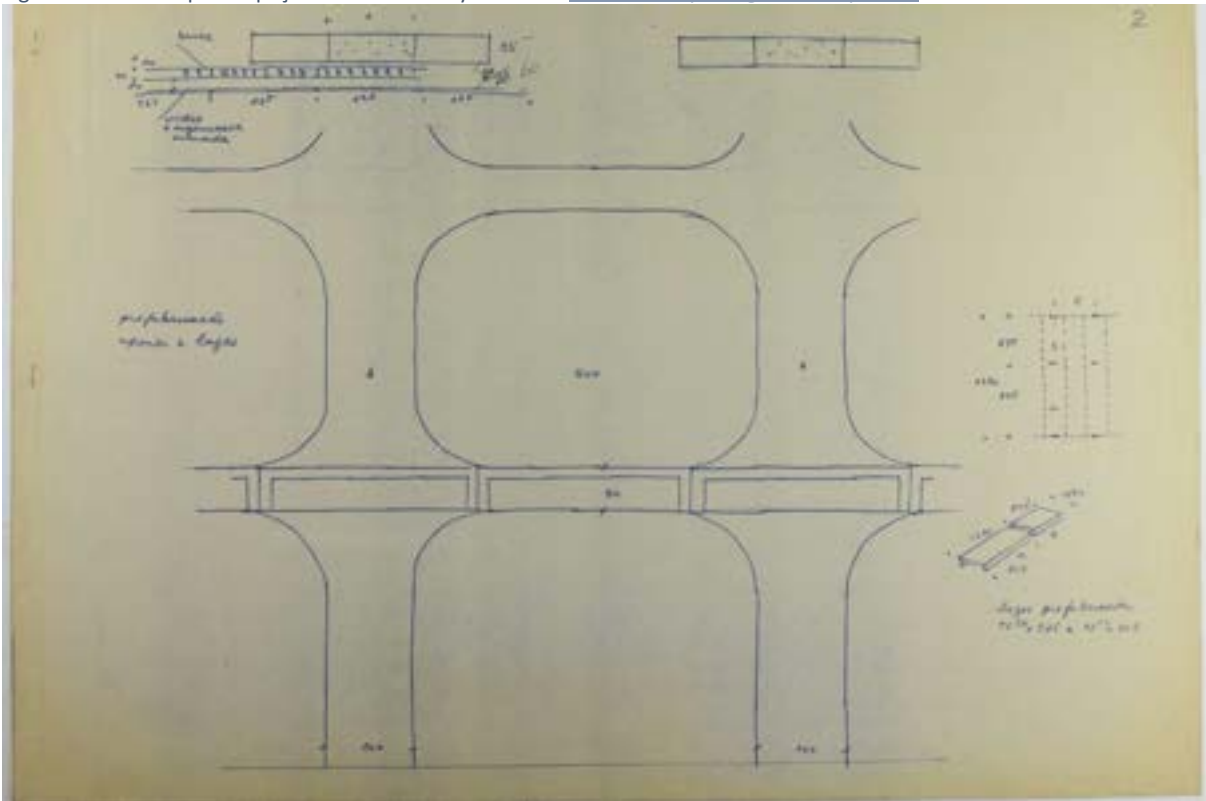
Croqui pavimento térreo – Oscar Niemeyer. Fonte: www.niemeyer.org.br/obra/pro192
